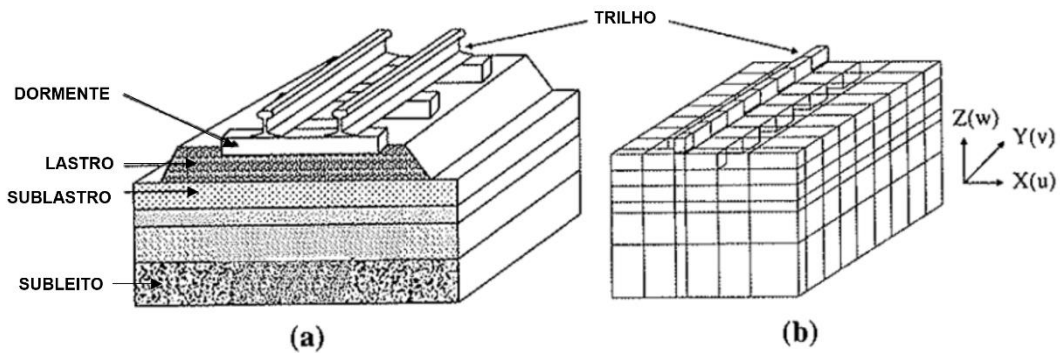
(a) pavimento ferroviário e (b) MEF do pavimento (Adaptado de PROFILLIDIS, 2014).
